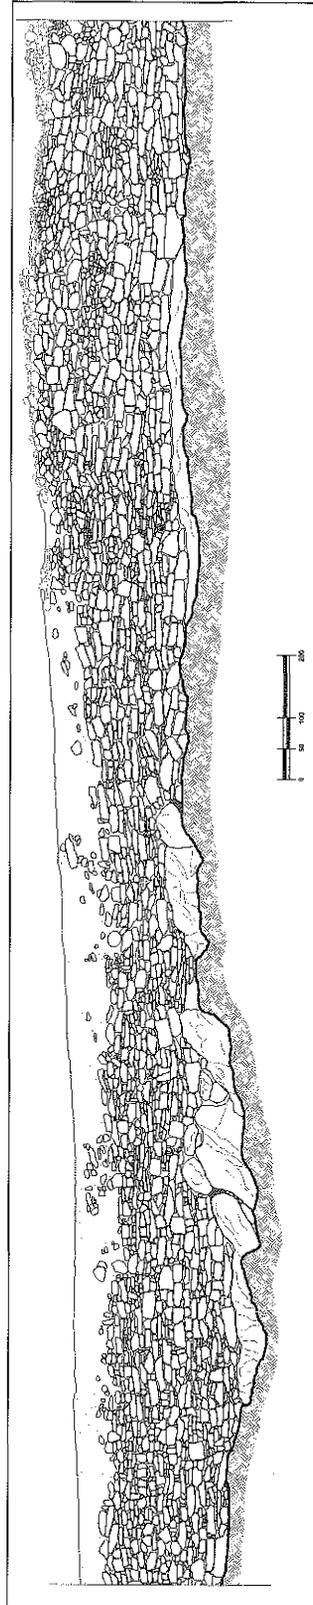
Pietramarina. Prospetto del paramento esterno delle mura ovest.
